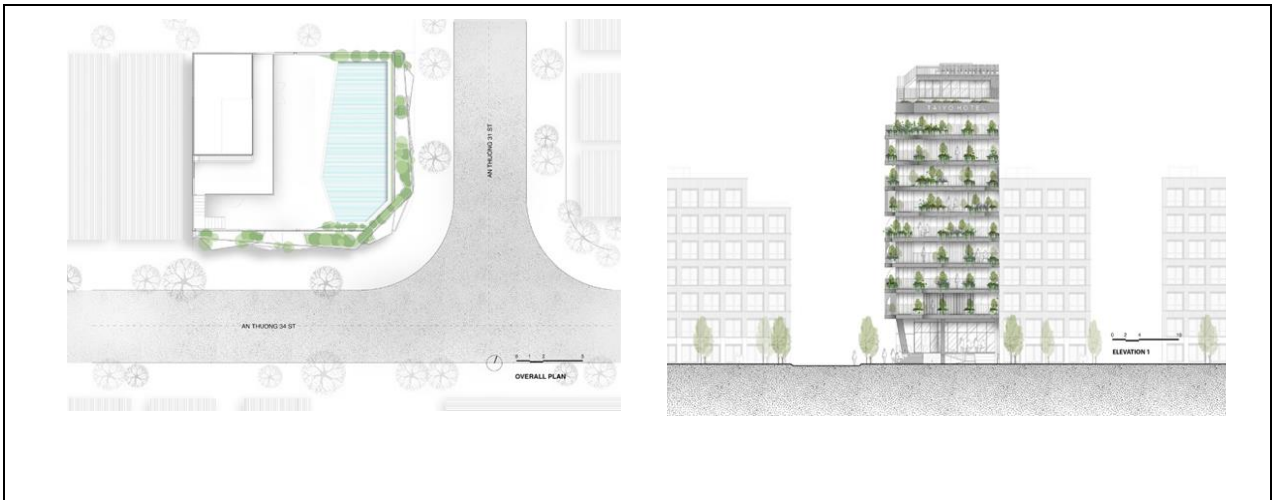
Схеми генерального плану та фасадного рішення житлового комплексу Taiyo Service Apartments [11]
